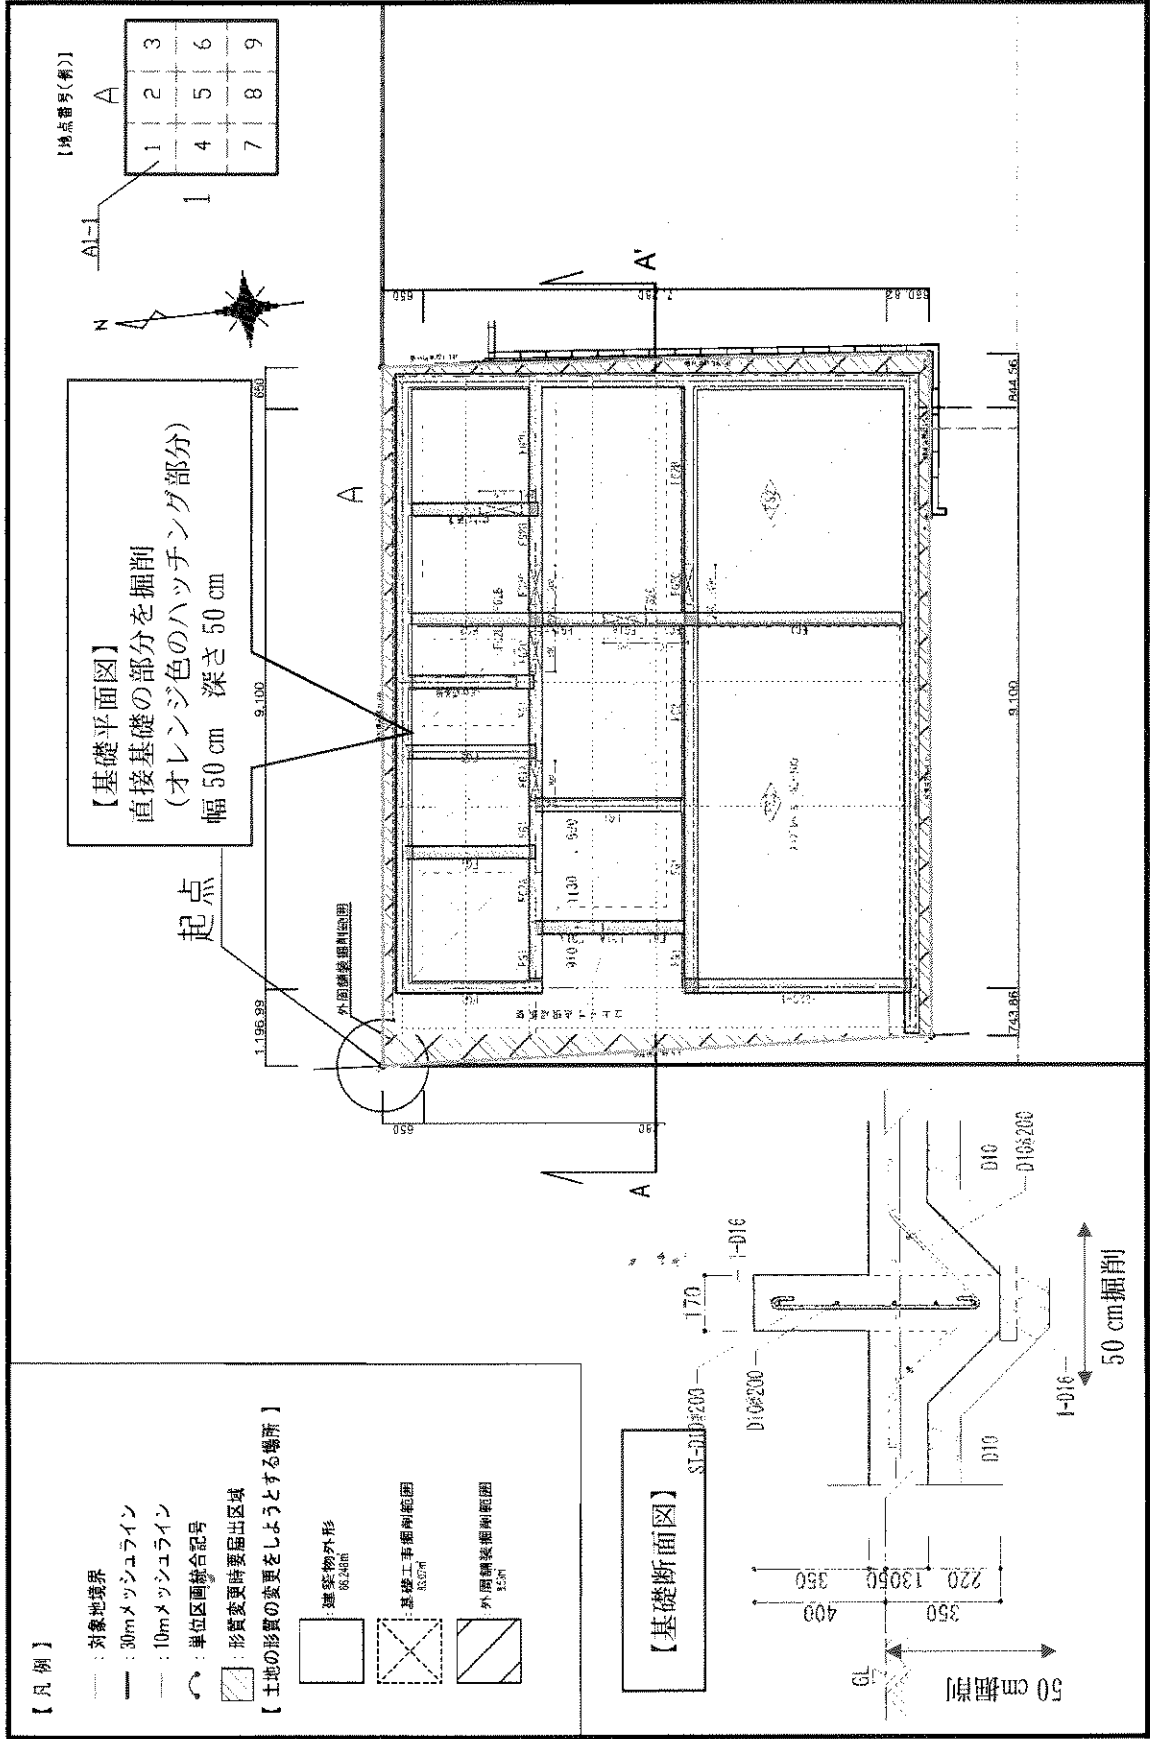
施工方法を明らかにした平面図・断面図（掘削部分）
